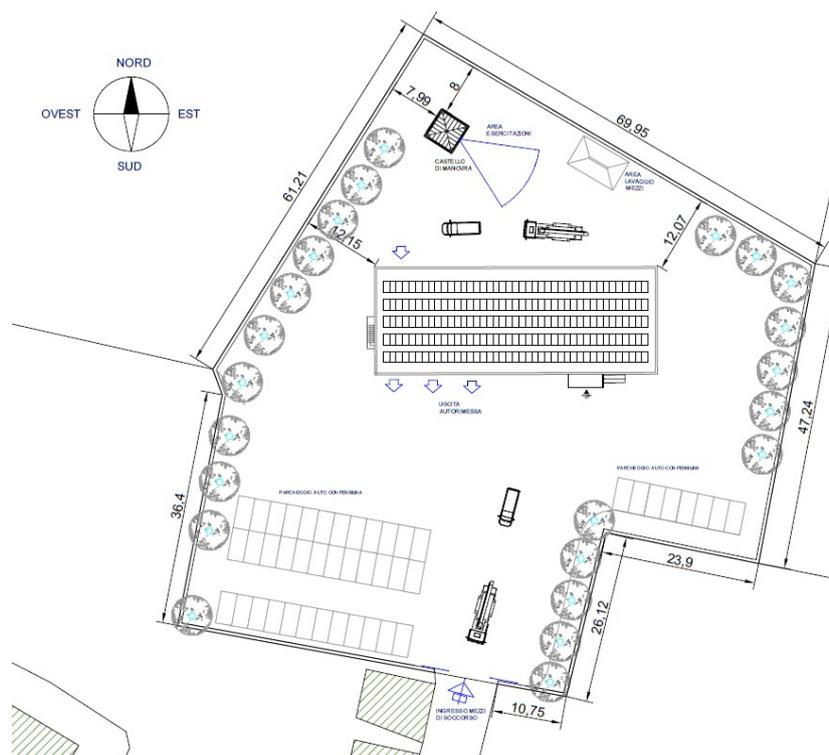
Planimetria generale con la disposizione dei pannelli fotovoltaici
